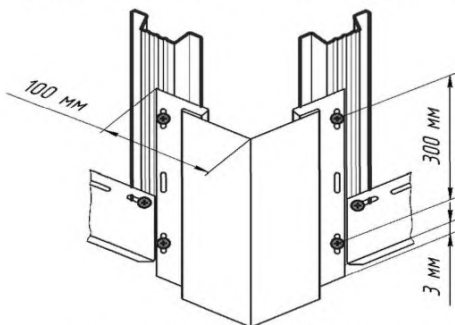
Крепление начальной планки ПОП1 и углового нащельника ПОН4-1
